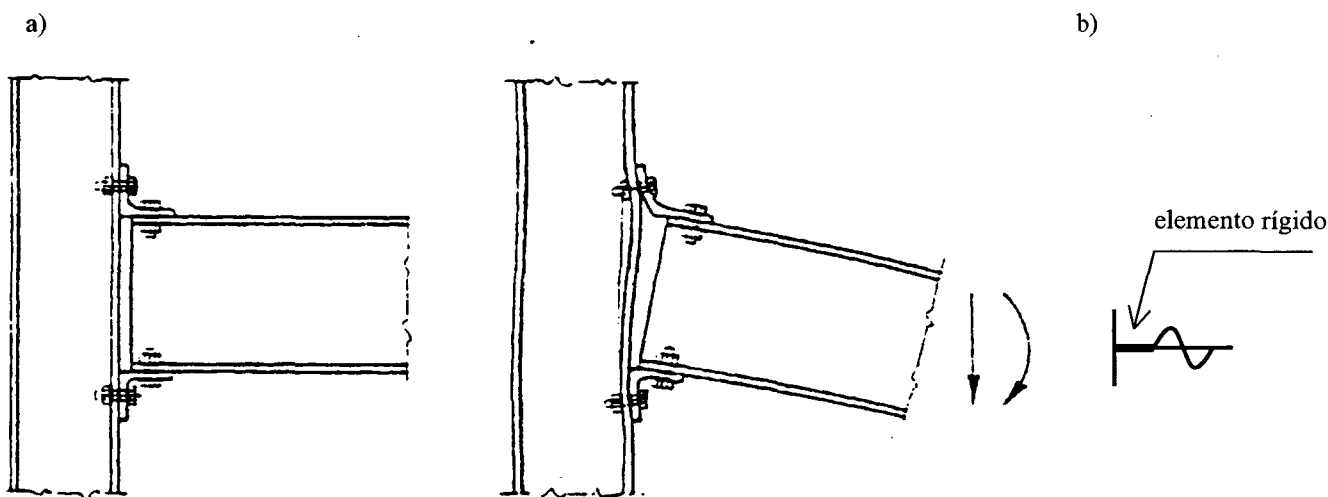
Conexão semi-rígida para viga orientada na mesa do pilar, segundo Kirby et al (1996), e modelamento com elemento rígido.
